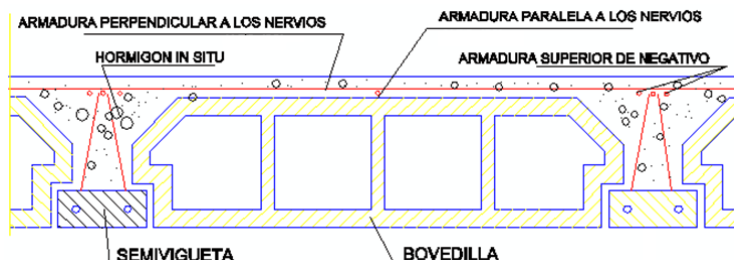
Sección de un forjado unidireccional de viguetas armadas (armadura en forma de triángulo) y bovedillas cerámicas.
